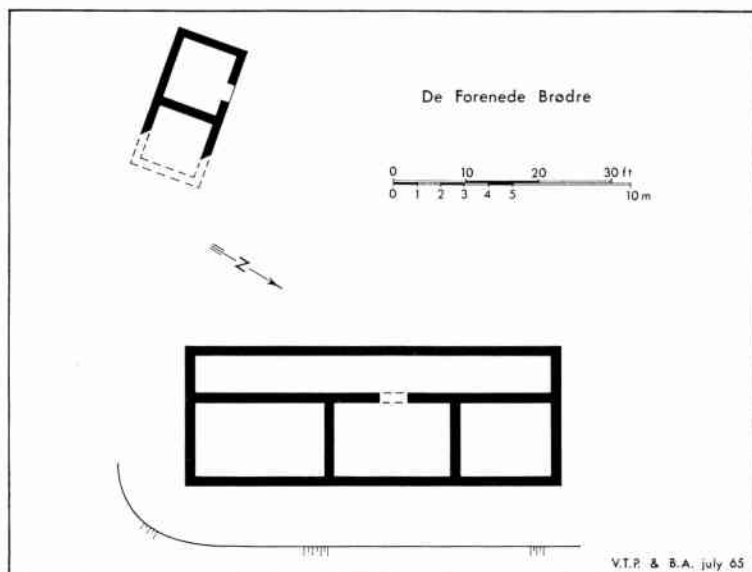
Plan over plantagebygningen „De forenede Brødre“.
